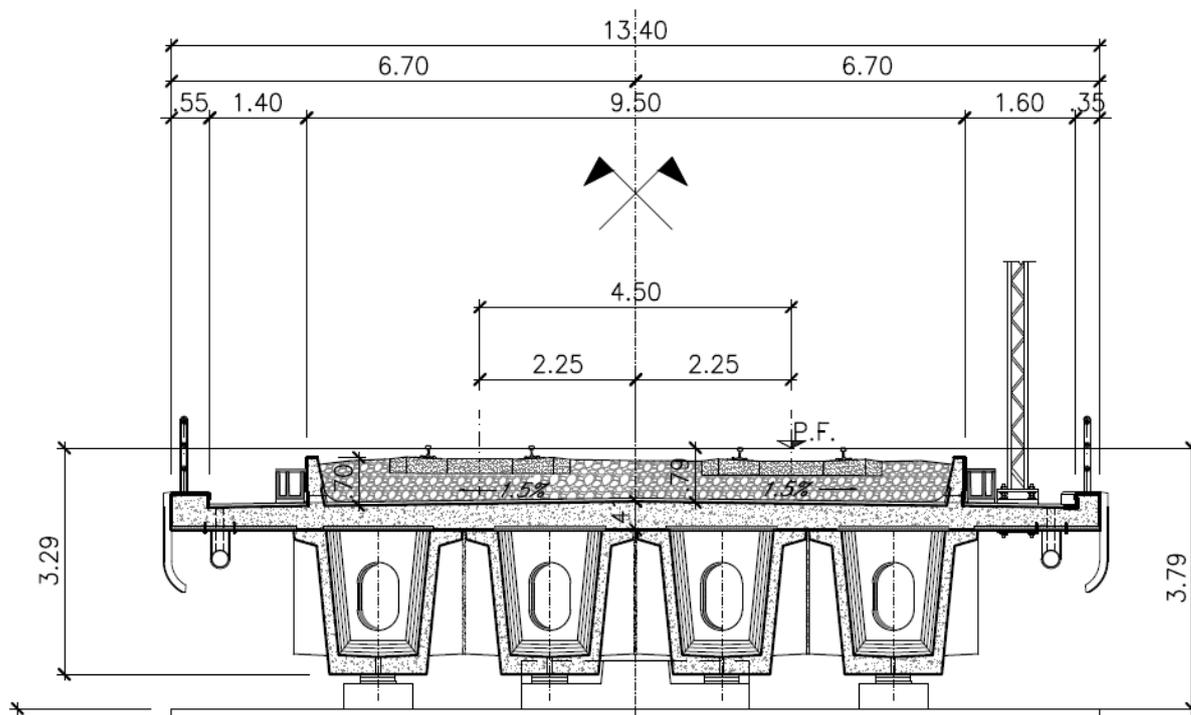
Sezione trasversale tipo dell'impalcato con travi in c.a.p.
